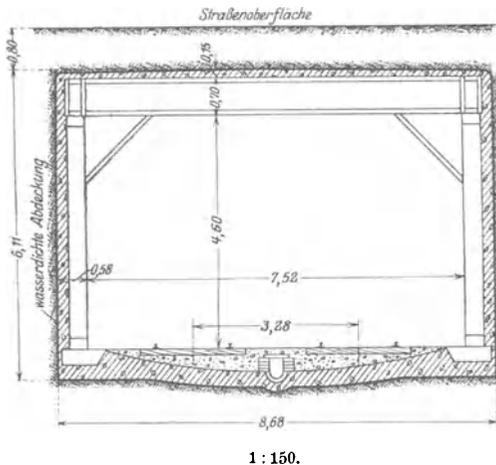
Straßentunnel in Boston (Park-Str. Subway), normaler Querschnitt.
